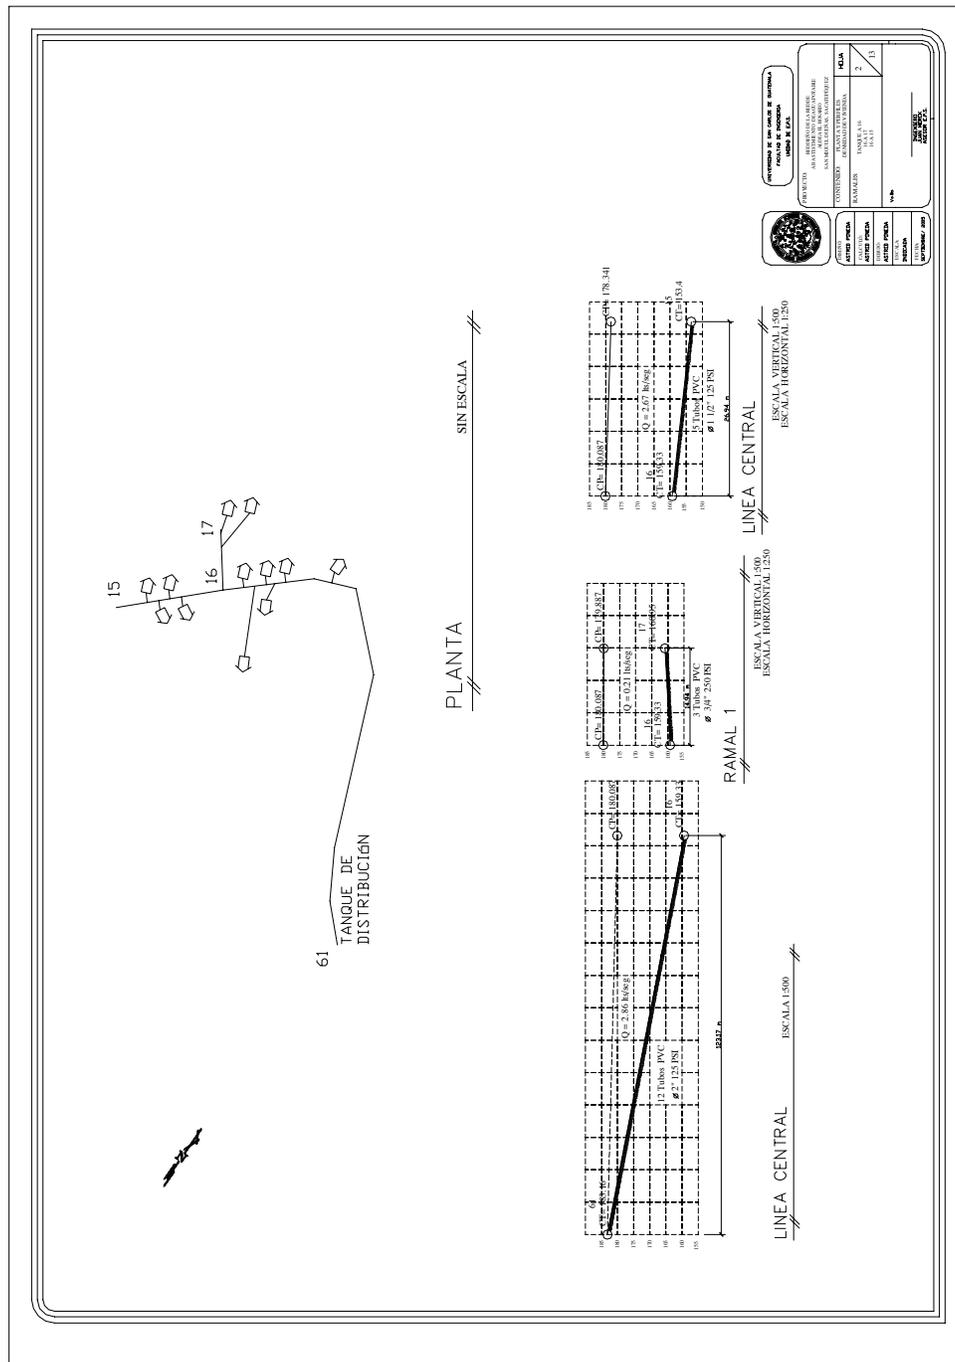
Planta y perfiles 34 a 37, 34 a 39, abastecimiento de agua potable
